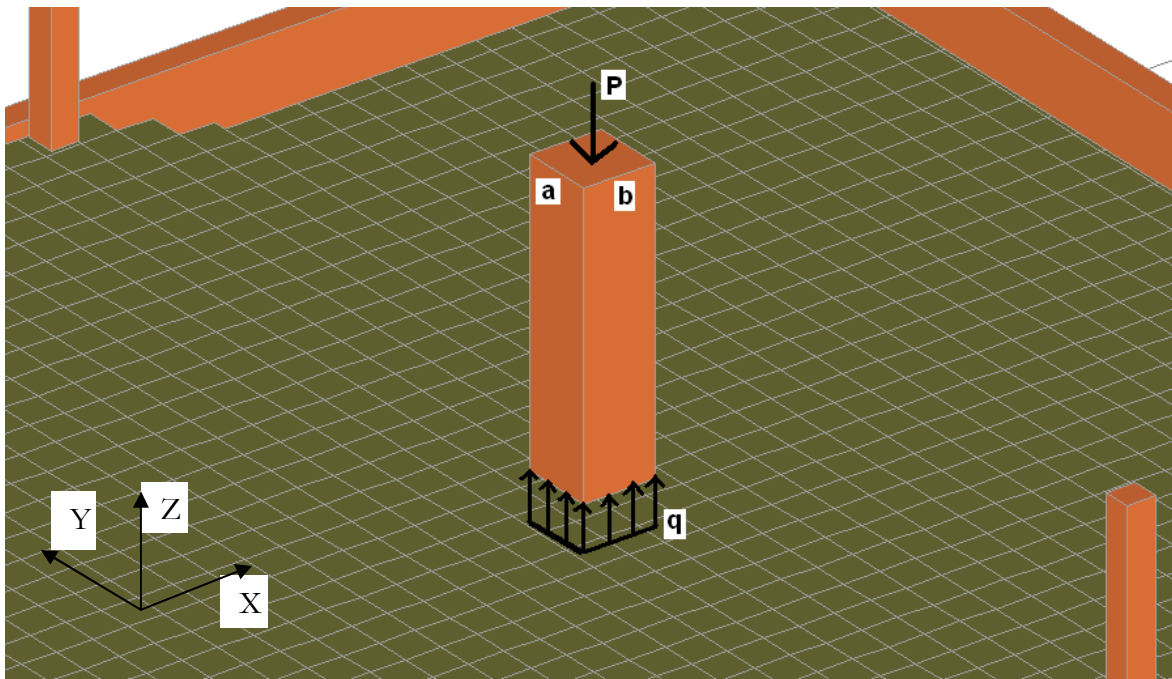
Carregamento uniformemente distribuído na laje representando a reação do pilar na projeção da área da seção transversal
